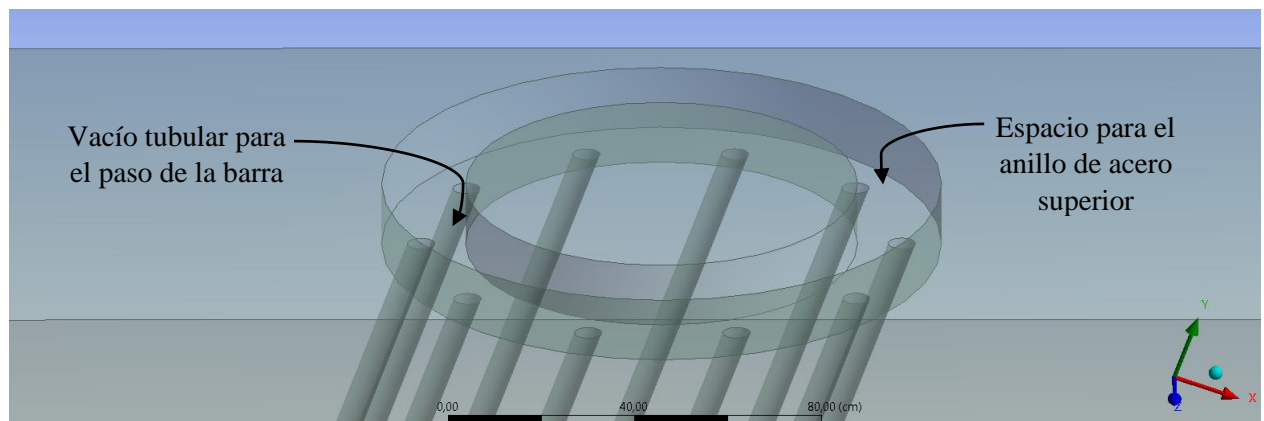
Detalle de la zona superior de la viga de hormigón.
